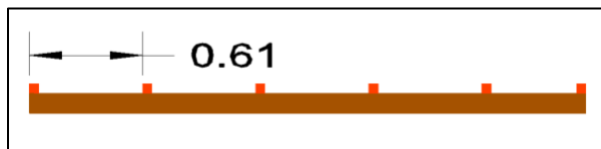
separación de vigas; Fuente: (Silva & Valencia, 2023)
